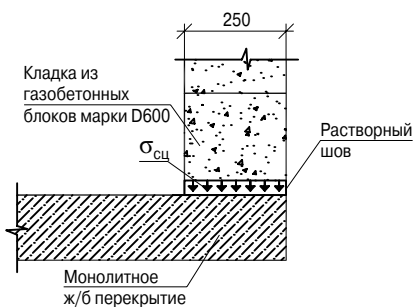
Схема сцепления первого ряда кладки с монолитным перекрытием
